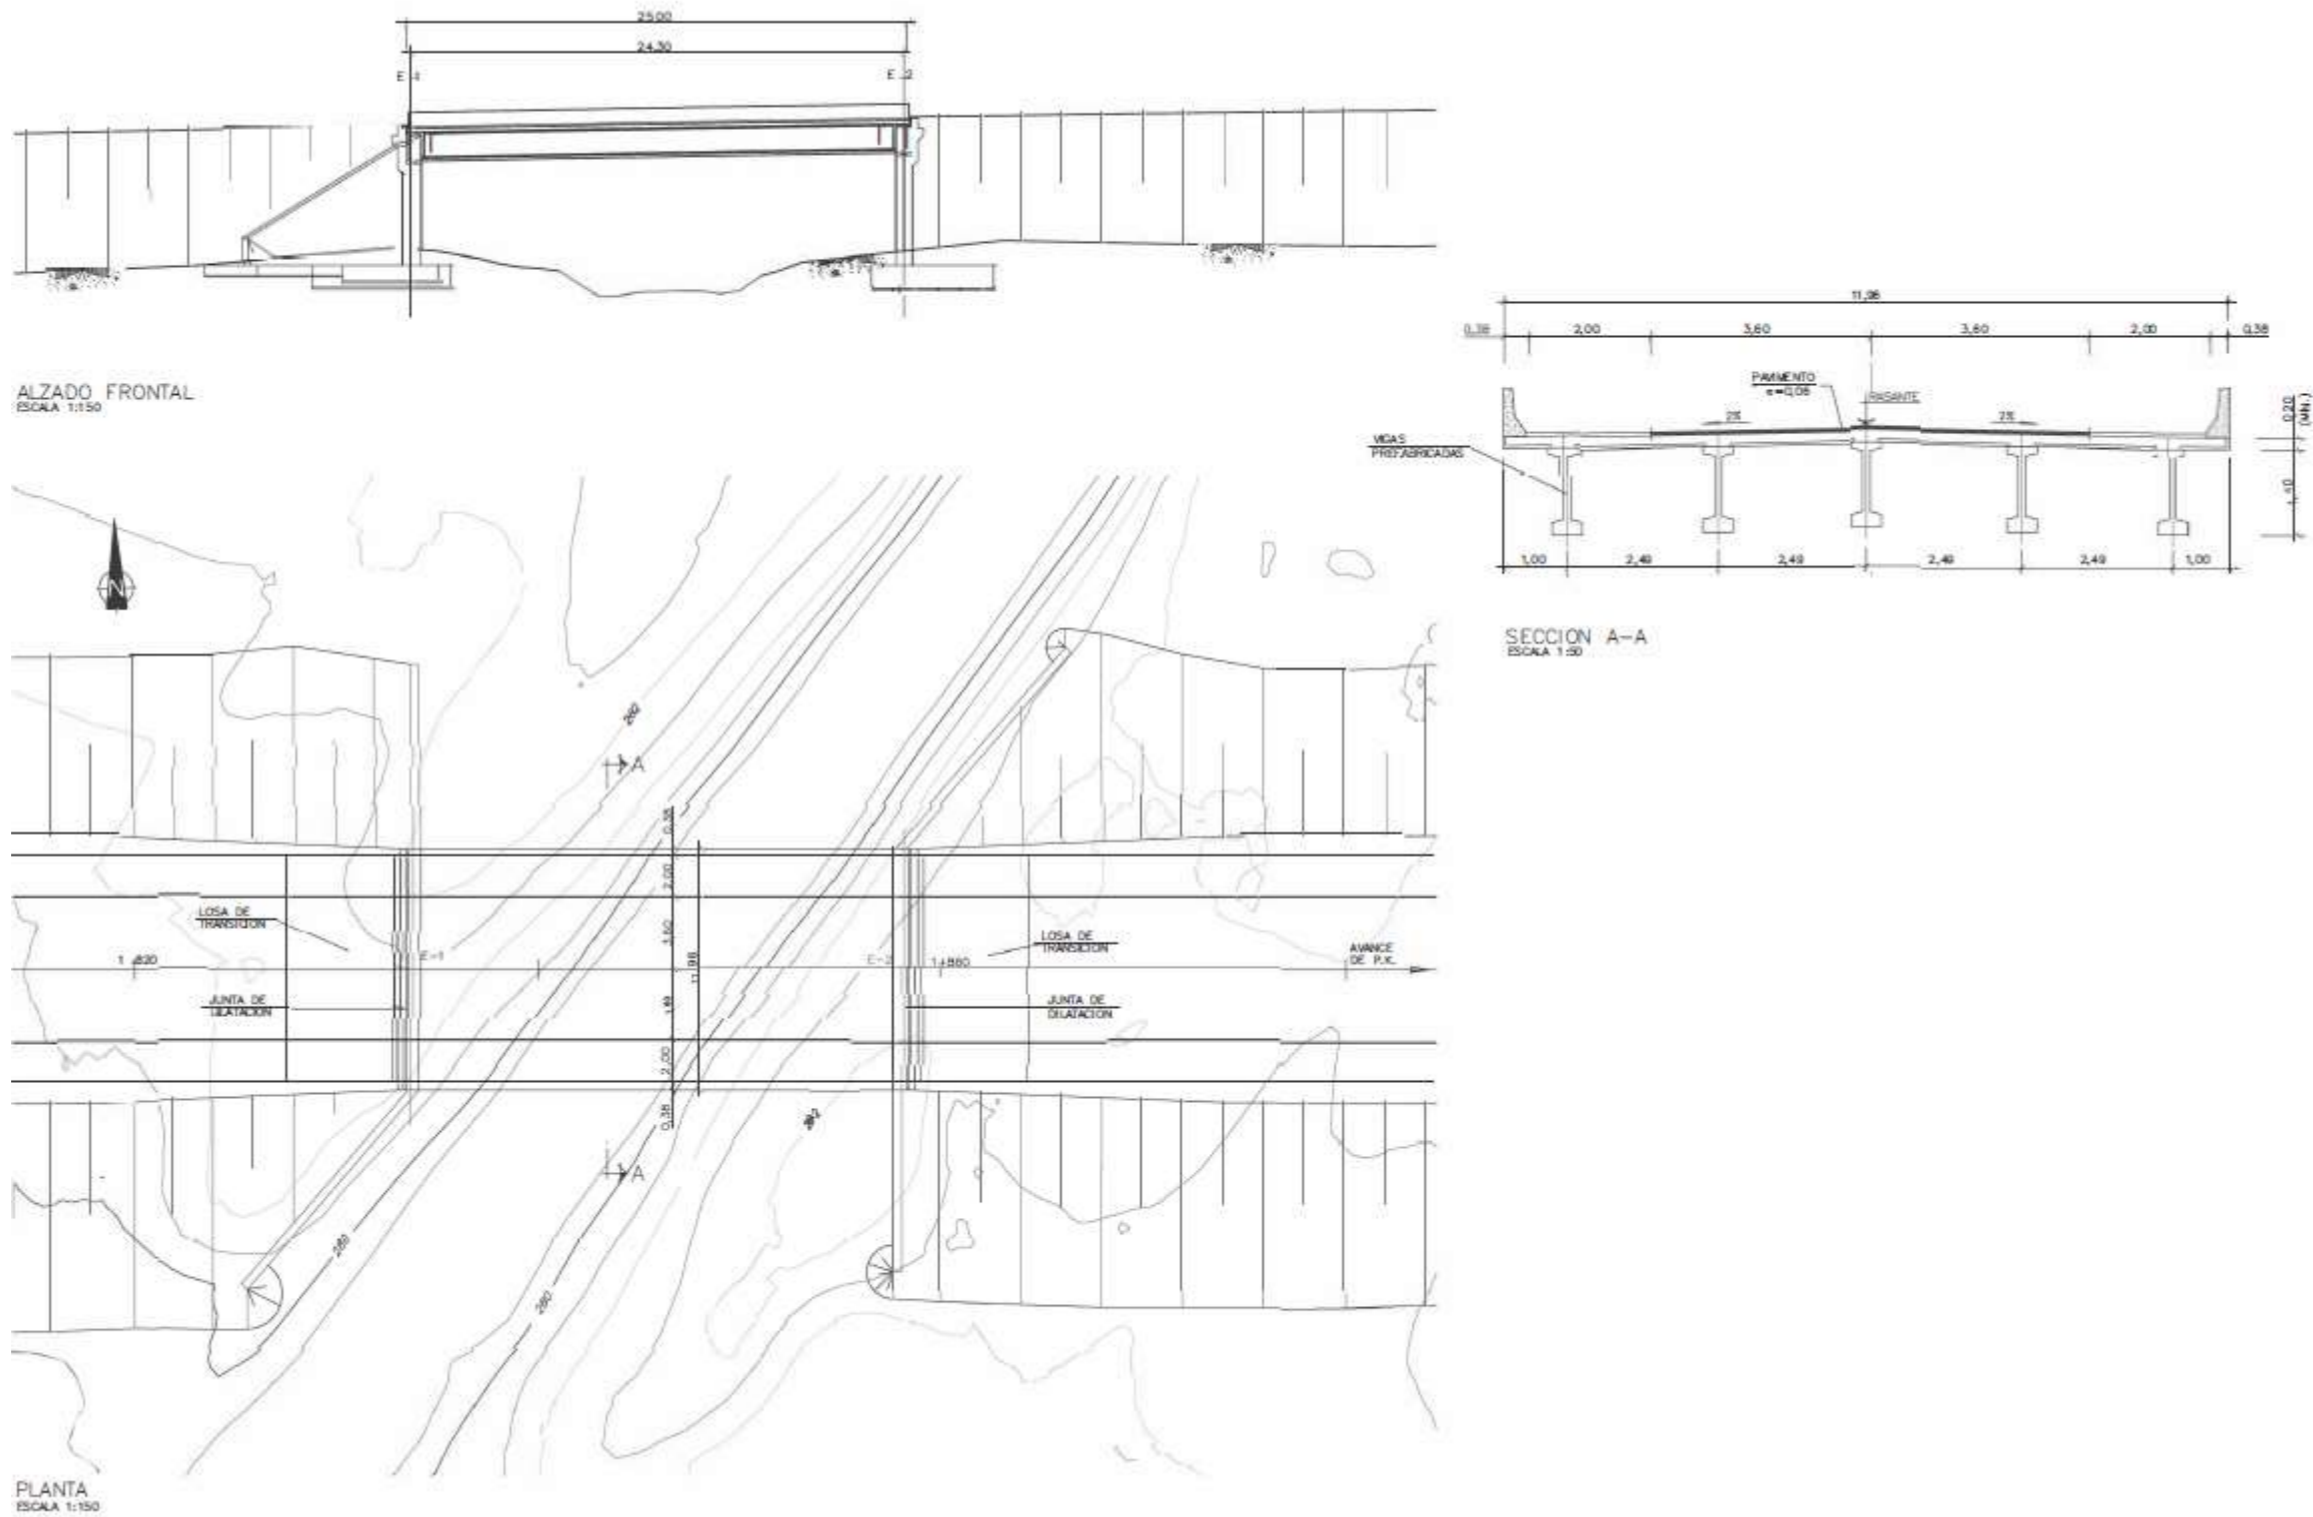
Extracto de plano de planta y corte del paso a desnivel
